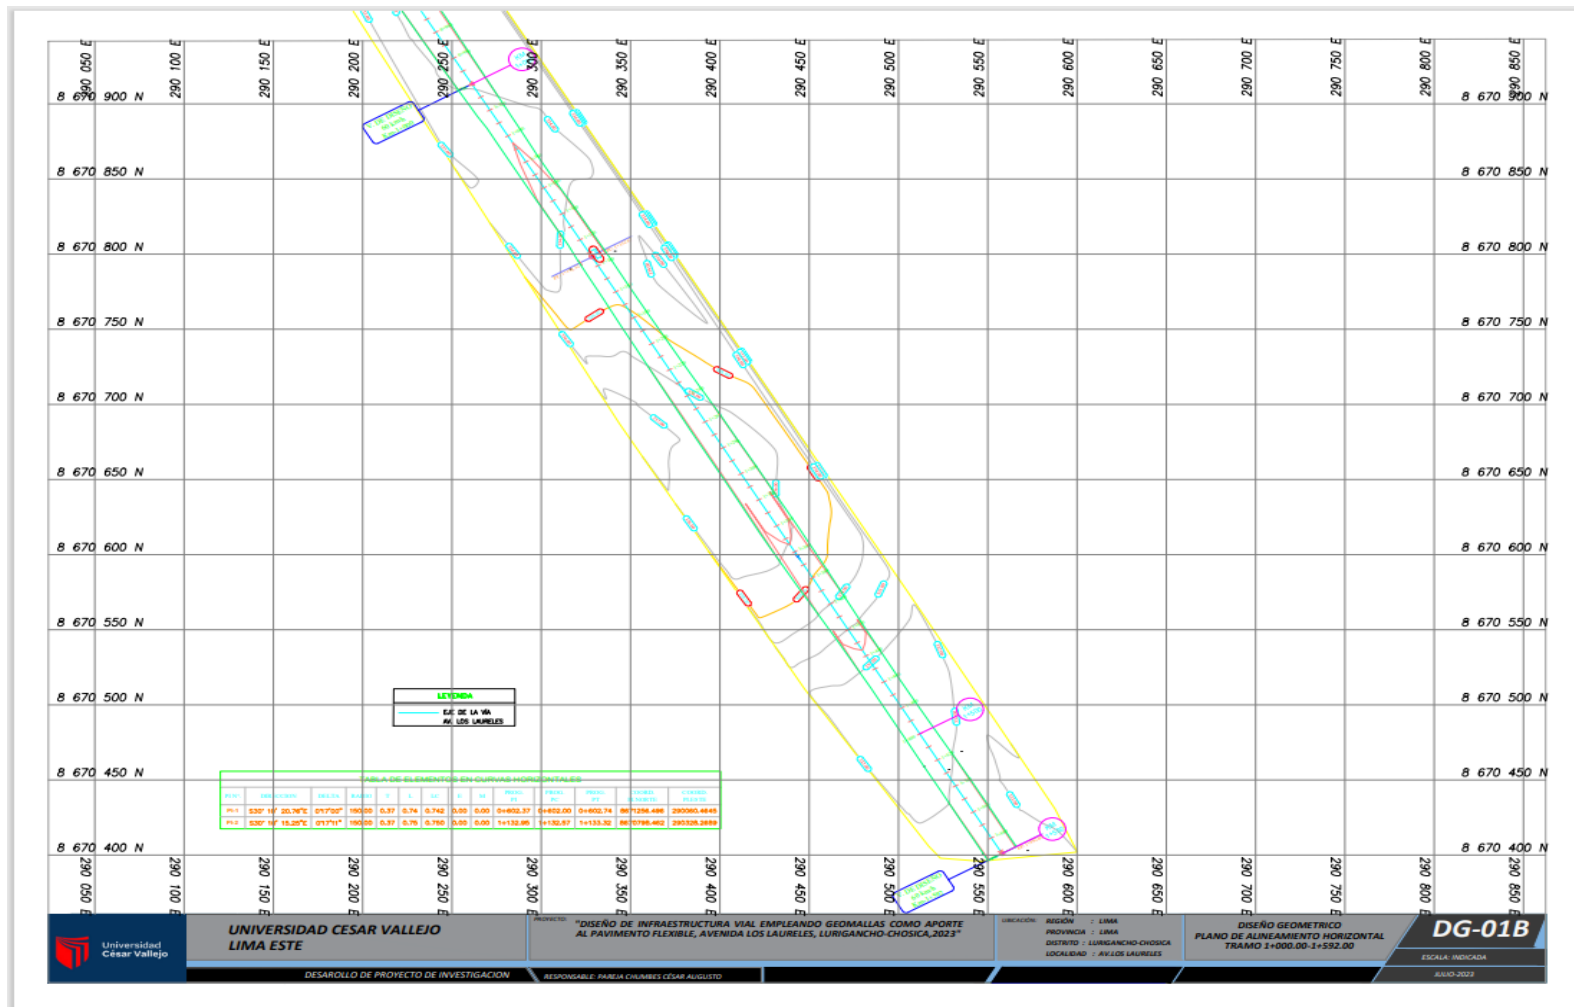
Alineamiento horizontal-Av. Los Laureles
